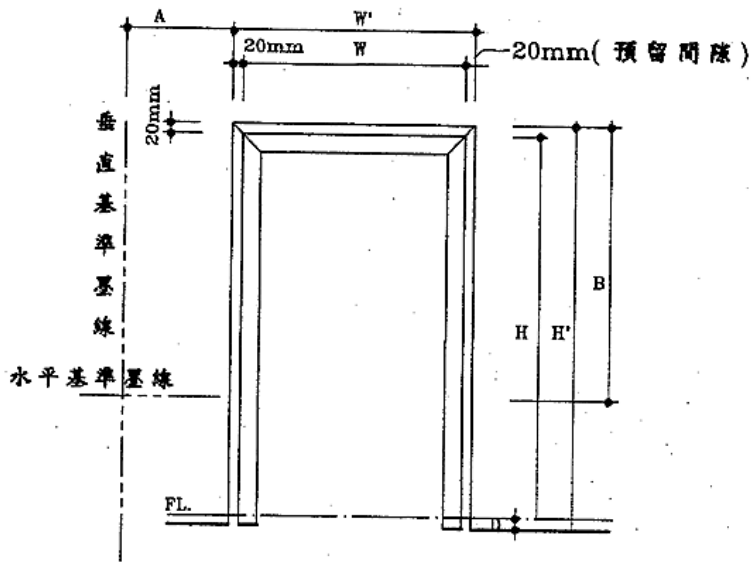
門預留孔圖(濕式施工)
